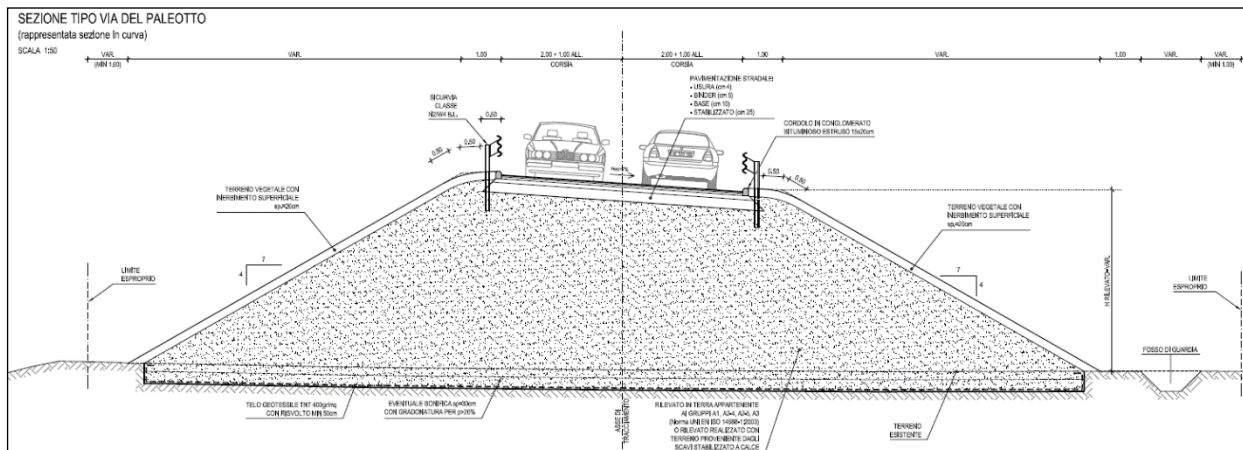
sezione trasversale tipica del collegamento a via del Paleotto.
